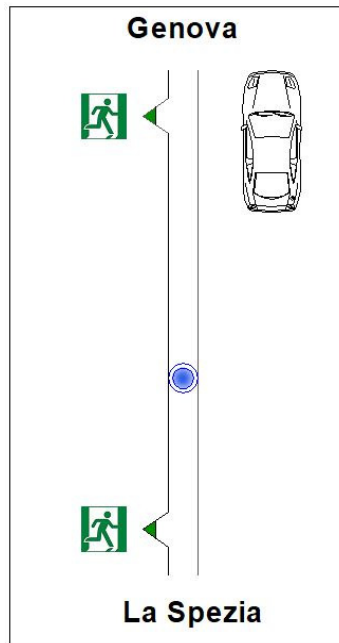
esempio di planimetria linearizzata per la navigazione pedonale in una galleria ad unico senso di marcia
